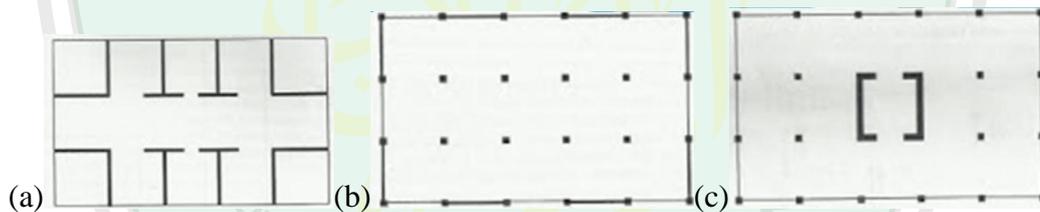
Sambungan plat lantai dengan struktur rangka kaku.
